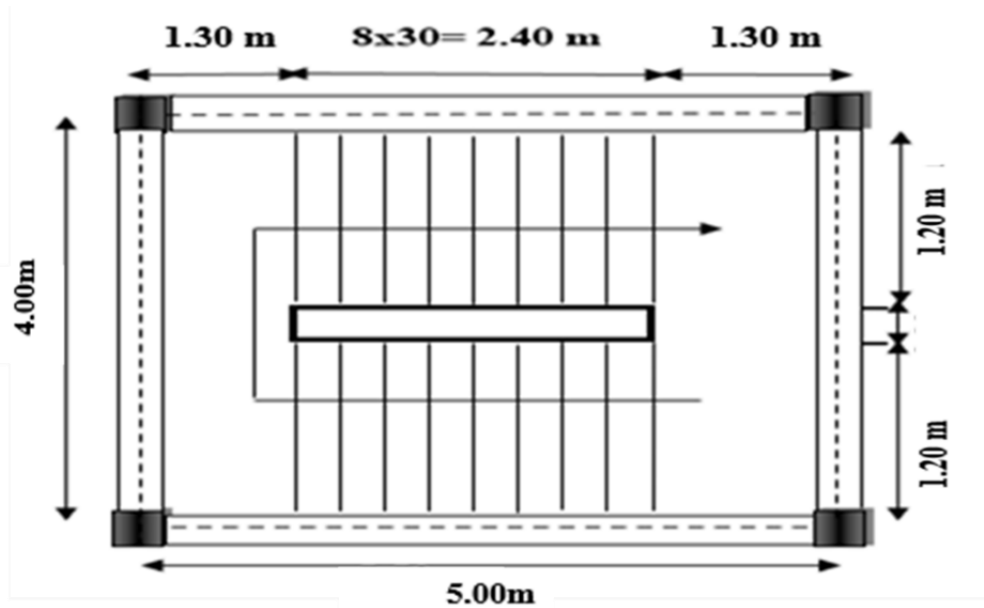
Schéma d'Escalier Coupe (A-A)
